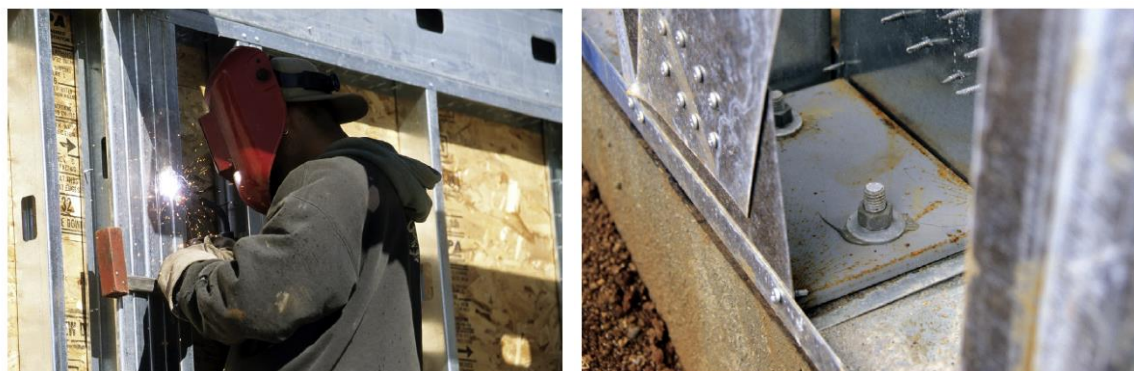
Assemblage par soudure et par boulonnage des éléments structuraux en acier formés à froid
